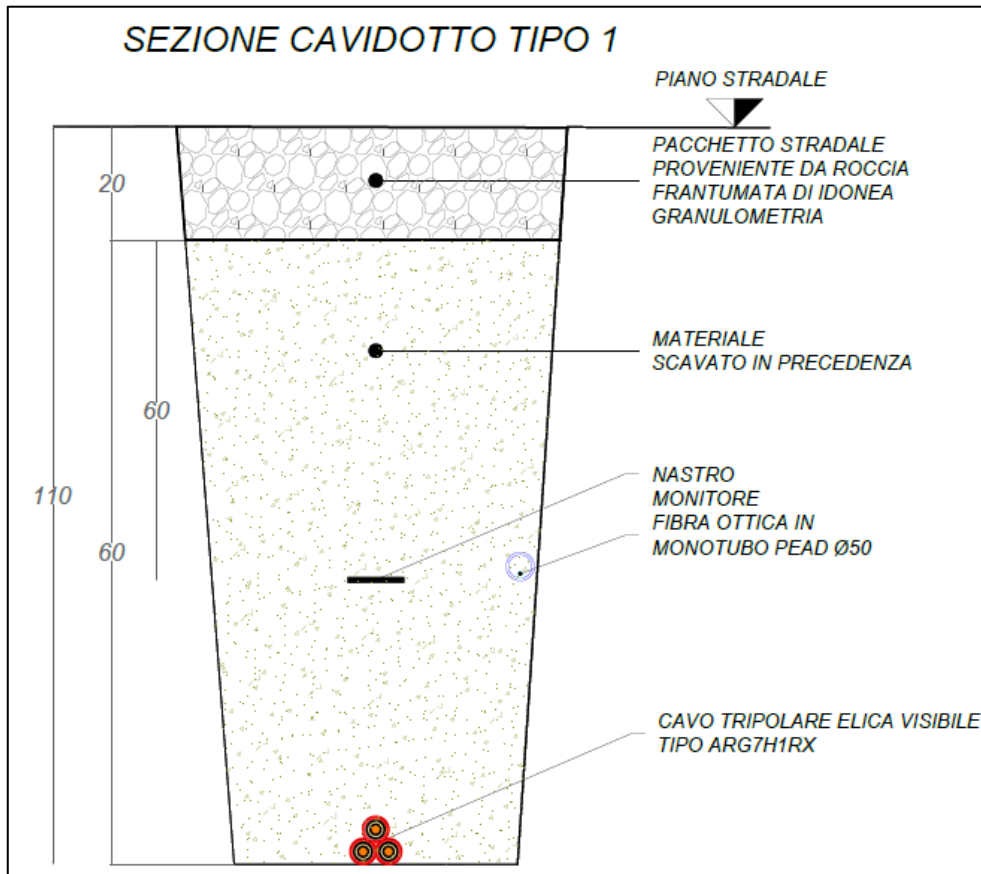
Sezione di posa cavidotto MT a 30 kV – tipo 1
